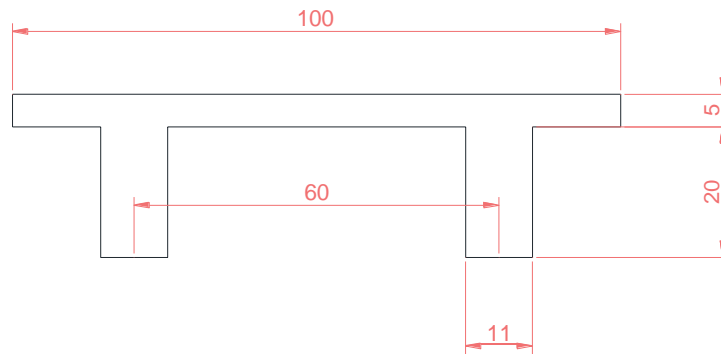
Losa Nervada de la Estructura B con aislación sísmica
